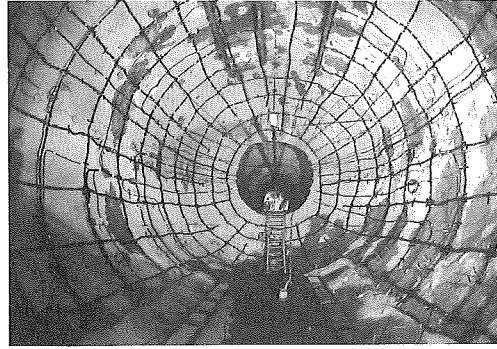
排水材施工終了状況(貯槽本体プラグ側)
